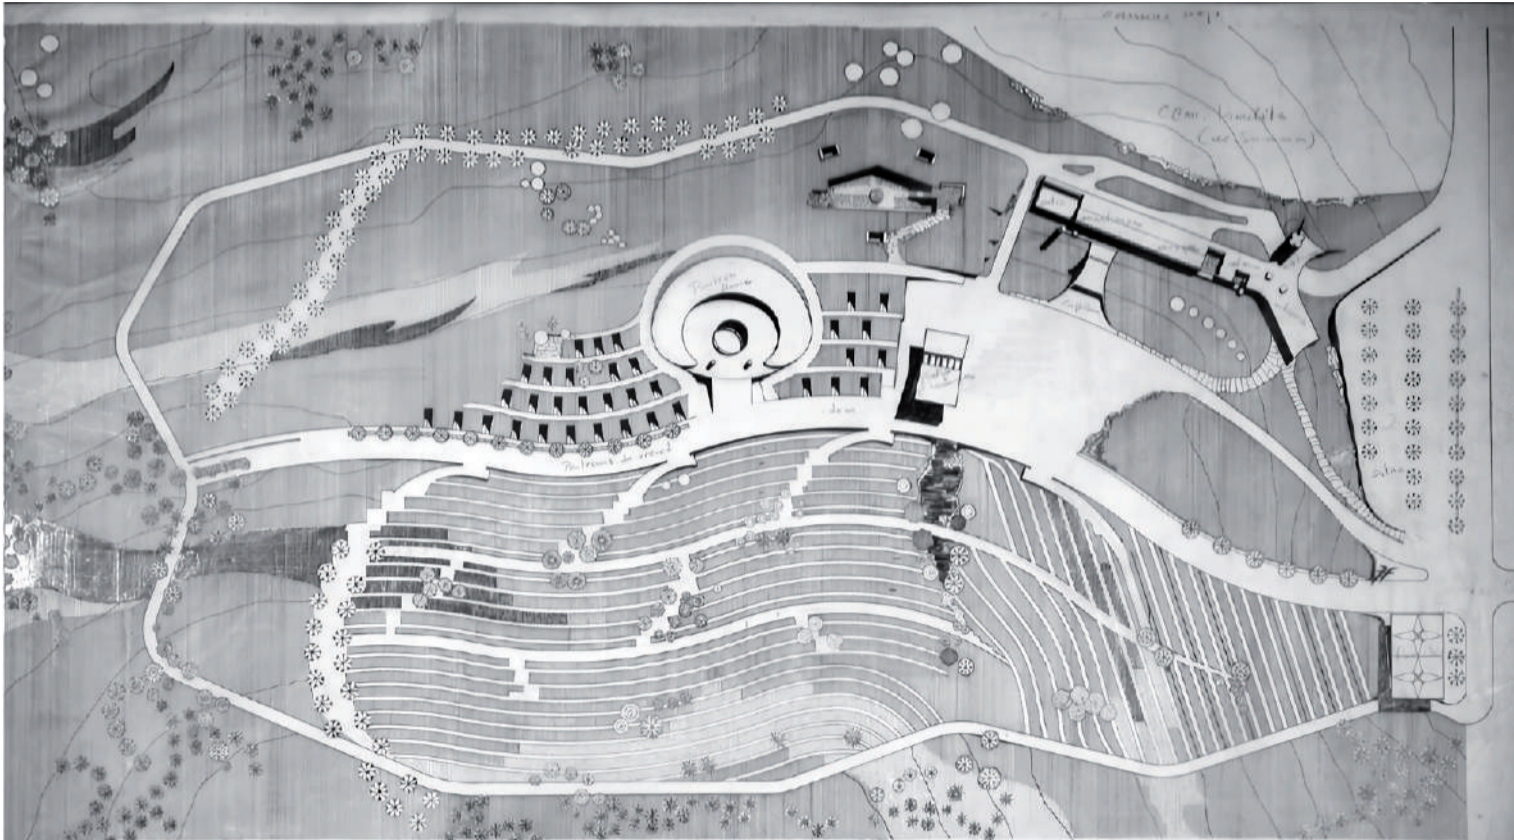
Horacio Baliero y Carmen Córdova, planta de conjunto, propuesta Concurso Nacional Cementerio de Mar del Plata, 1961. Dibujo técnico en tinta negra. Archivo Dar Digital Universidad de Buenos Aires.
